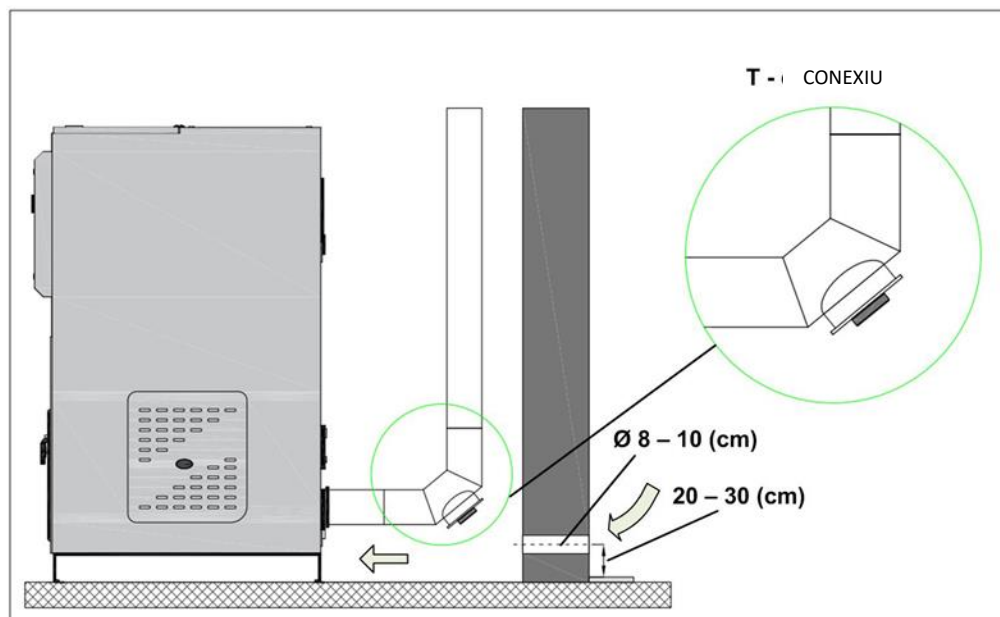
Distanțe minime pentru instalarea grilelor de ventilație
